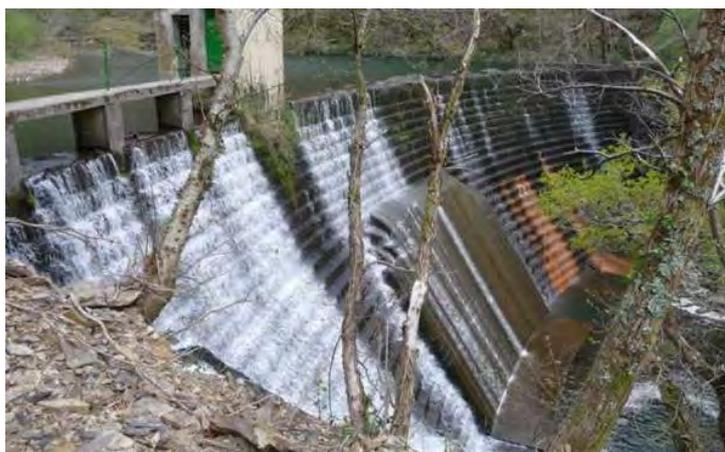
Vista de la presa de Inturia en el río Leizaran. Fuente: blog.leizaran.net
